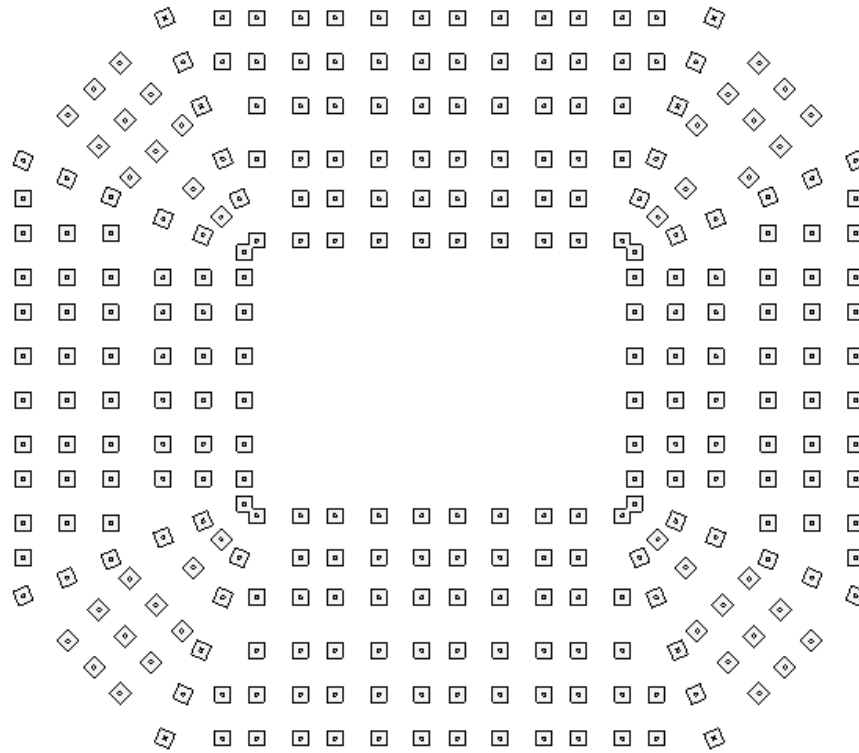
Vista en planta de la distribución pilares y zapatas. Fuente: elaboración propia
